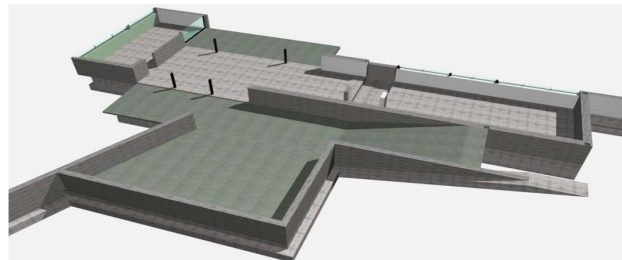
Maqueta estructural filtrada seccionada por la planta de acceso. 2012. Curso Interoperabilidad. Cfp. Universidad de Sevilla
